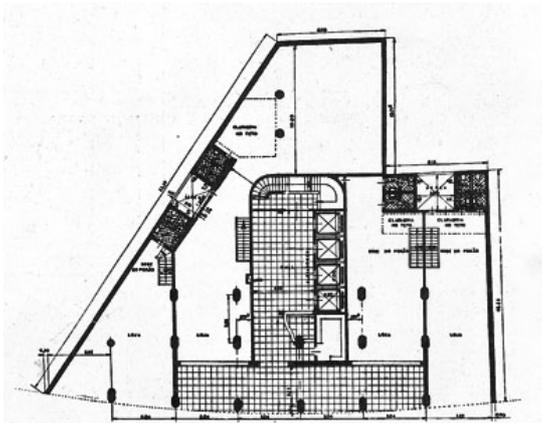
Planta Pavimento Térreo; Esther e Arthur Nogueira
